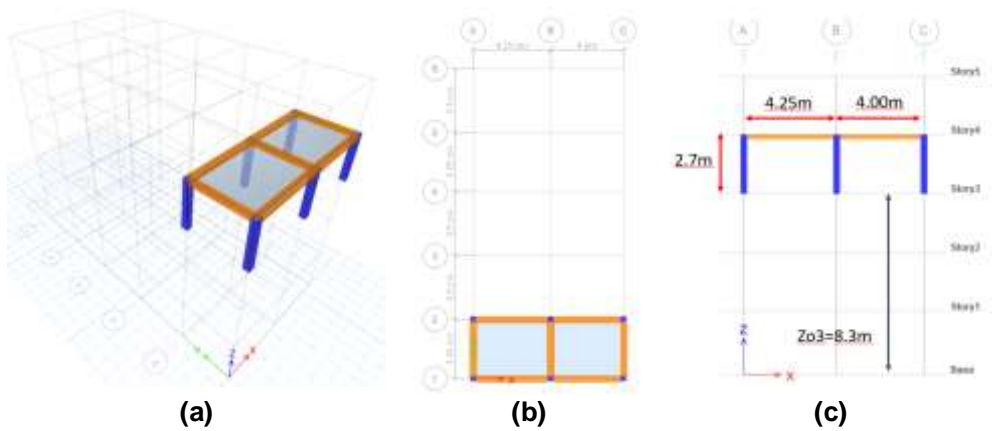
Parte 2 del Bloque Estructural; a) Vista tridimensional; b) Vista en planta; c) Pórtico tipo en sentido X.
